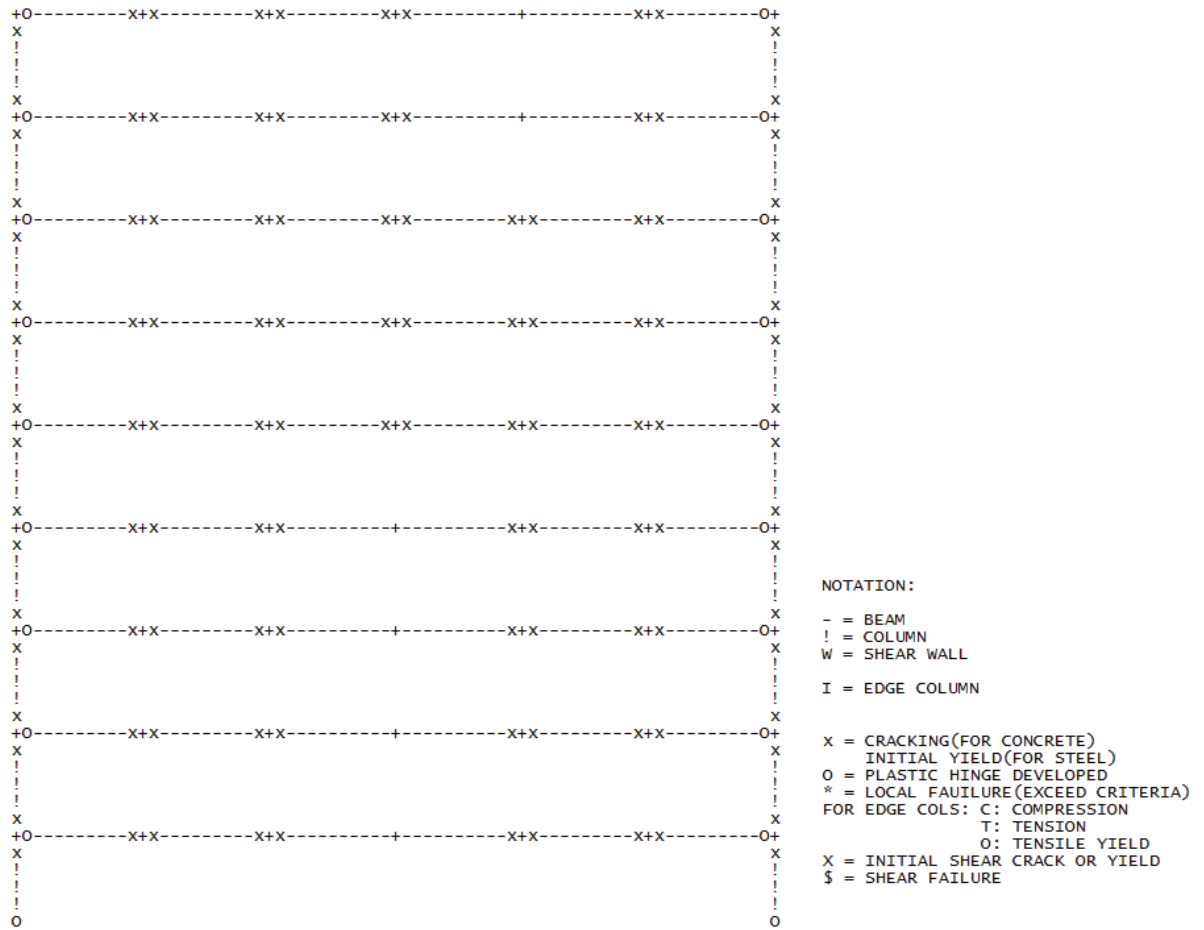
Mecanismo de colapso del pórtico convencional de nueve plantas
